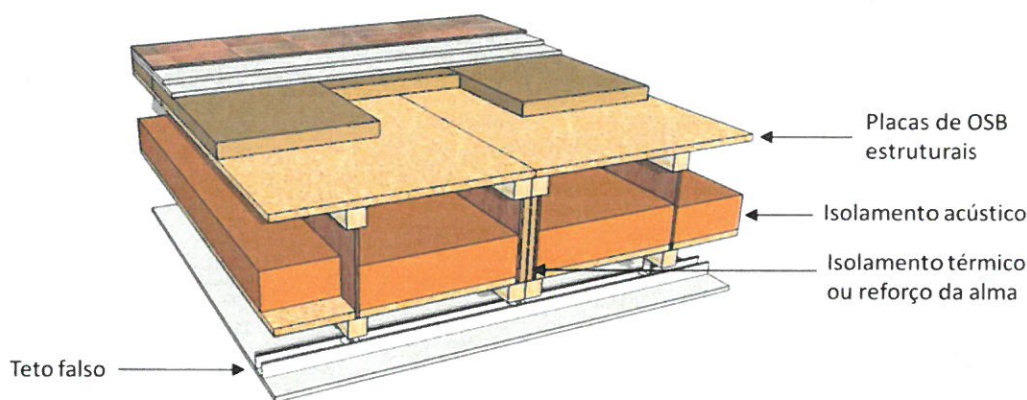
Exemplo de utilização de vigas I em soluções de piso (sistema STEICOjoist)
